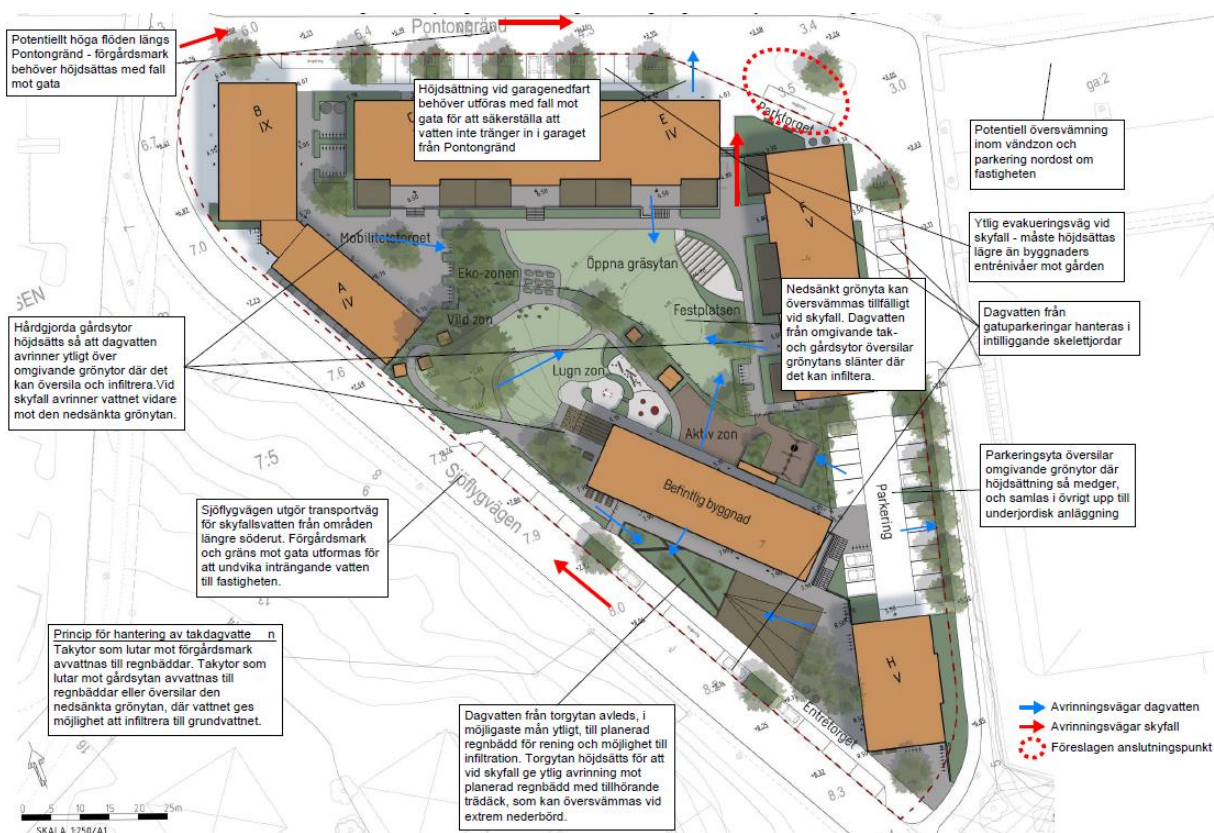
Föreslagen dagvattenhantering inom det norra kvarteret. Bild: Structor.
